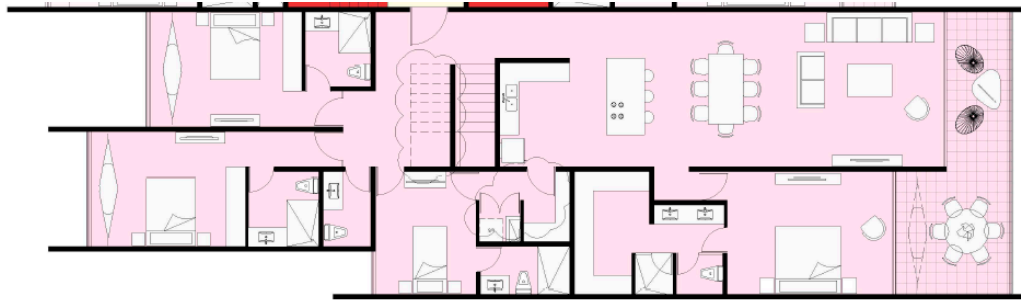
PLANTA ALTA PENTHOUSE TIPO A
